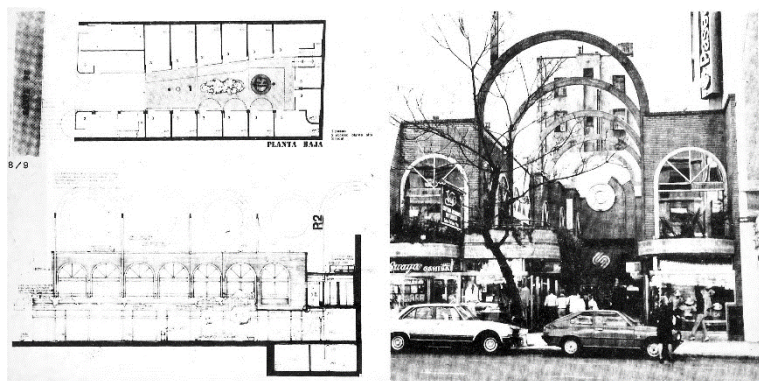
Paseo Santa Fe, Buenos Aires (arriba a la izquierda: planta baja; abajo a la derecha: sección longitudinal; derecha: foto desde Av. Santa Fe), por Juan Carlos López y Asociados, 1984, *A/mbiente*, (43).
